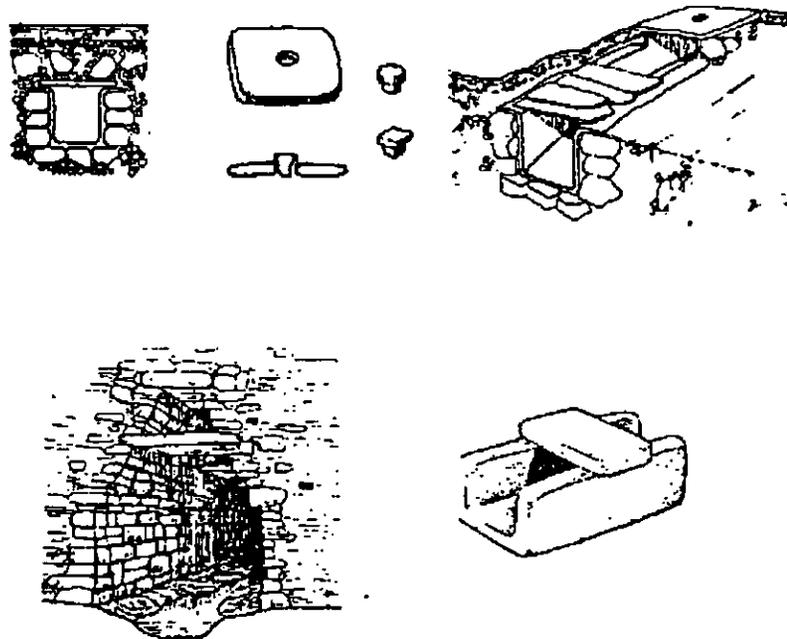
Alcantarilla (detalles palacios teotihuacanos) Sistema de alcantarilla pluvial.
